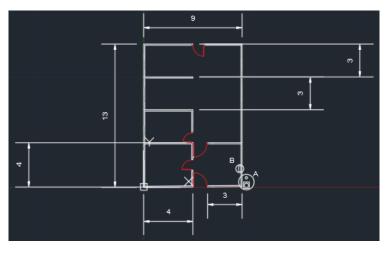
Plano ubicación de los paneles solares y el panel de mando. (Autor)
